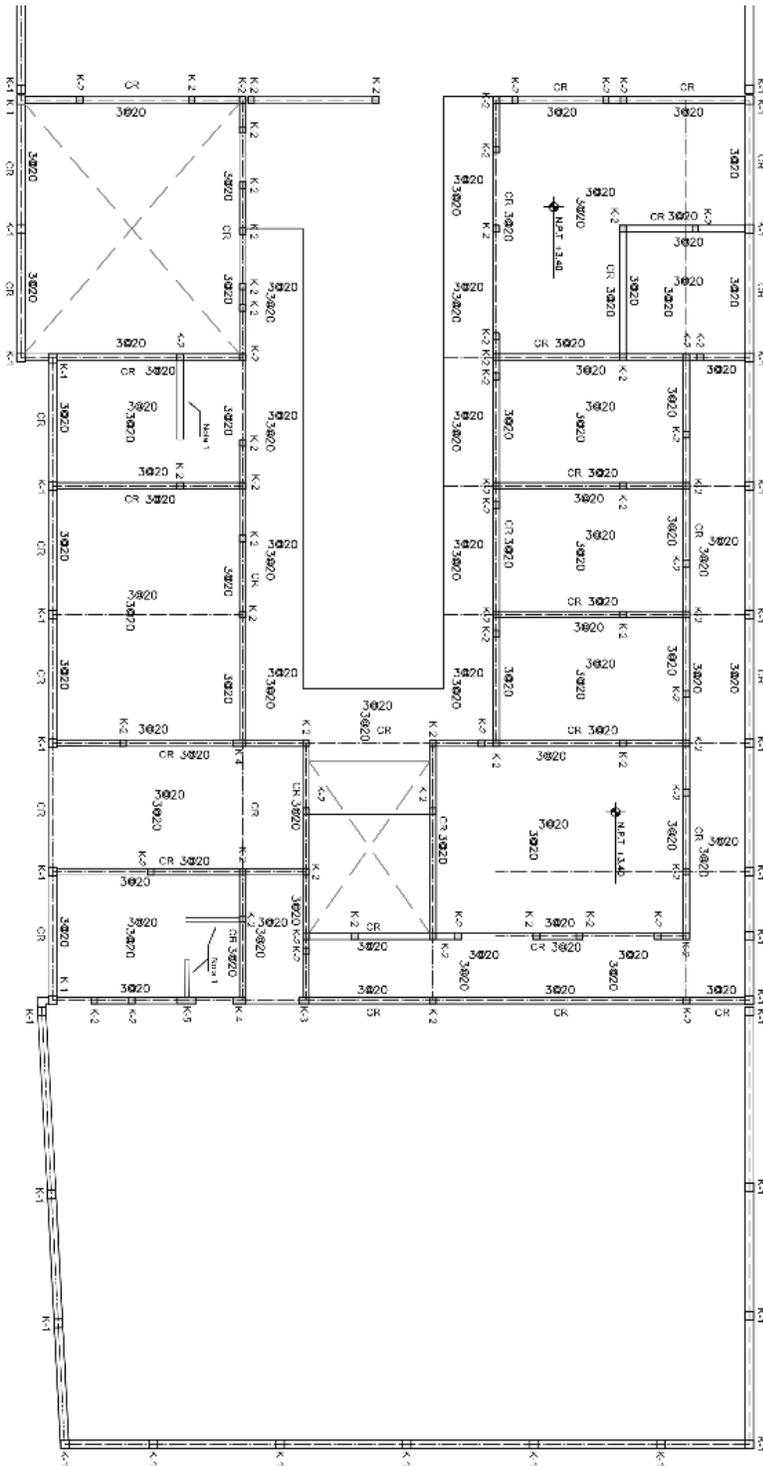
| Explicación de la Planta de cimentación zona de administración de MUSAS / Realización propia. / 2023
